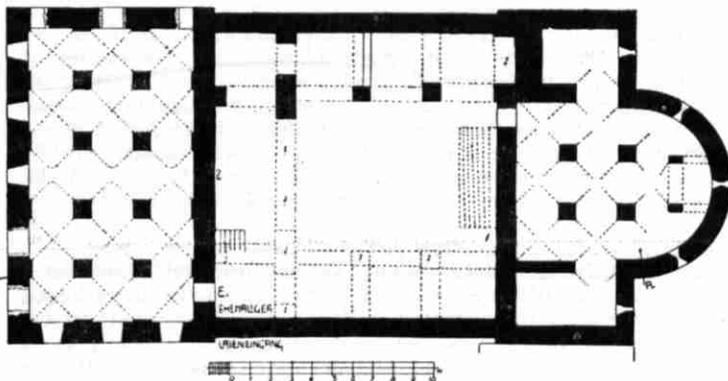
Ehemalige Klosterkirche auf dem Münzenberge. Versuch einer Darstellung des Grundrisses auf Grund der vorhandenen Reste.
